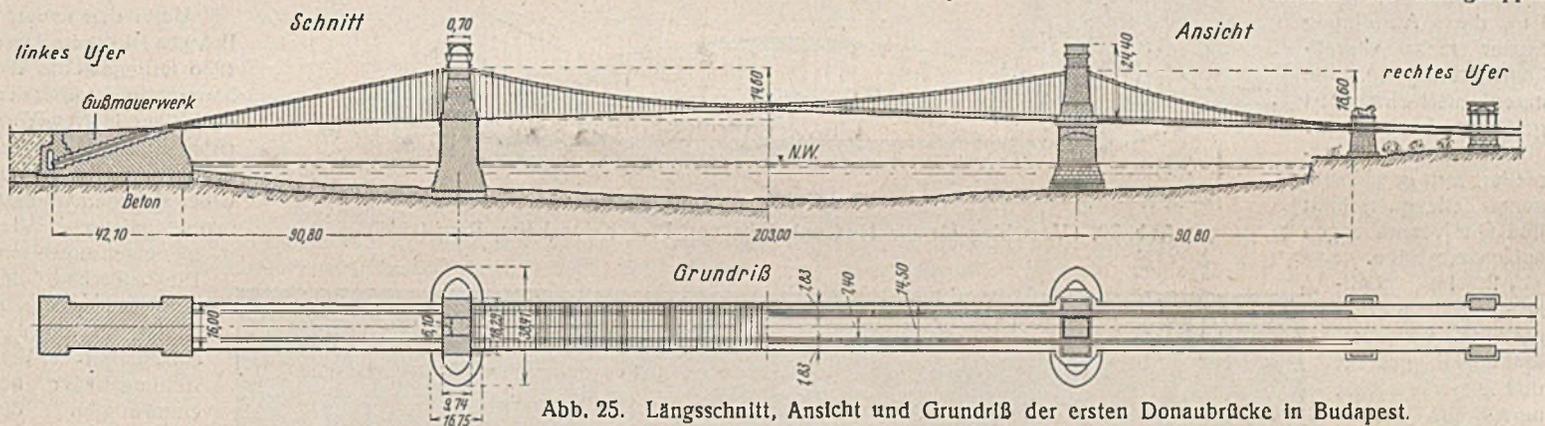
Längsschnitt, Ansicht und Grundriß der ersten Donaubrücke in Budapest.
